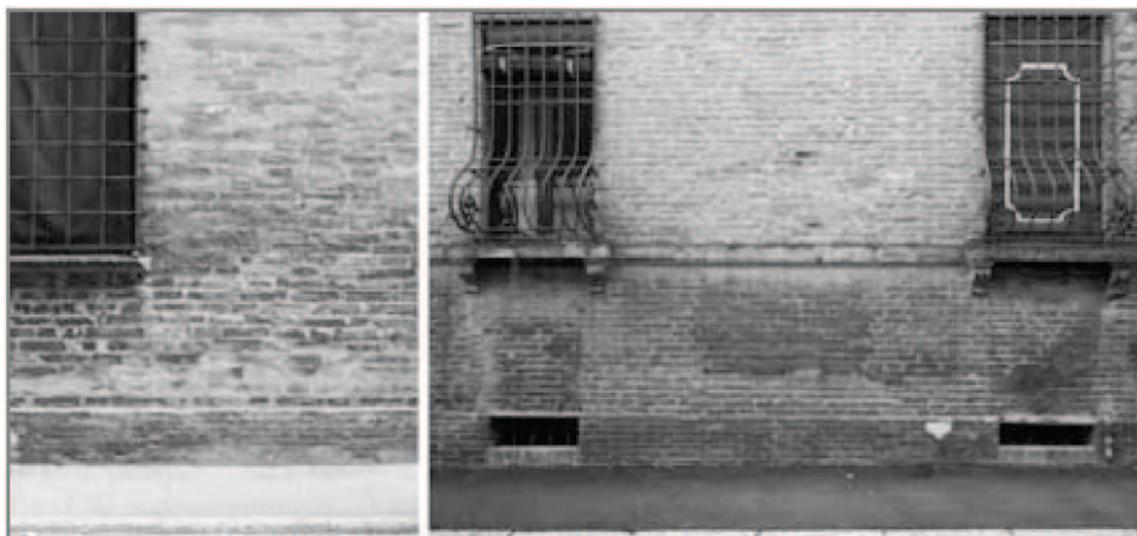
Ferrara, esempi di caratterizzazione locale e codificazione architettonica nella connessione tra parete e piano di campagna.
